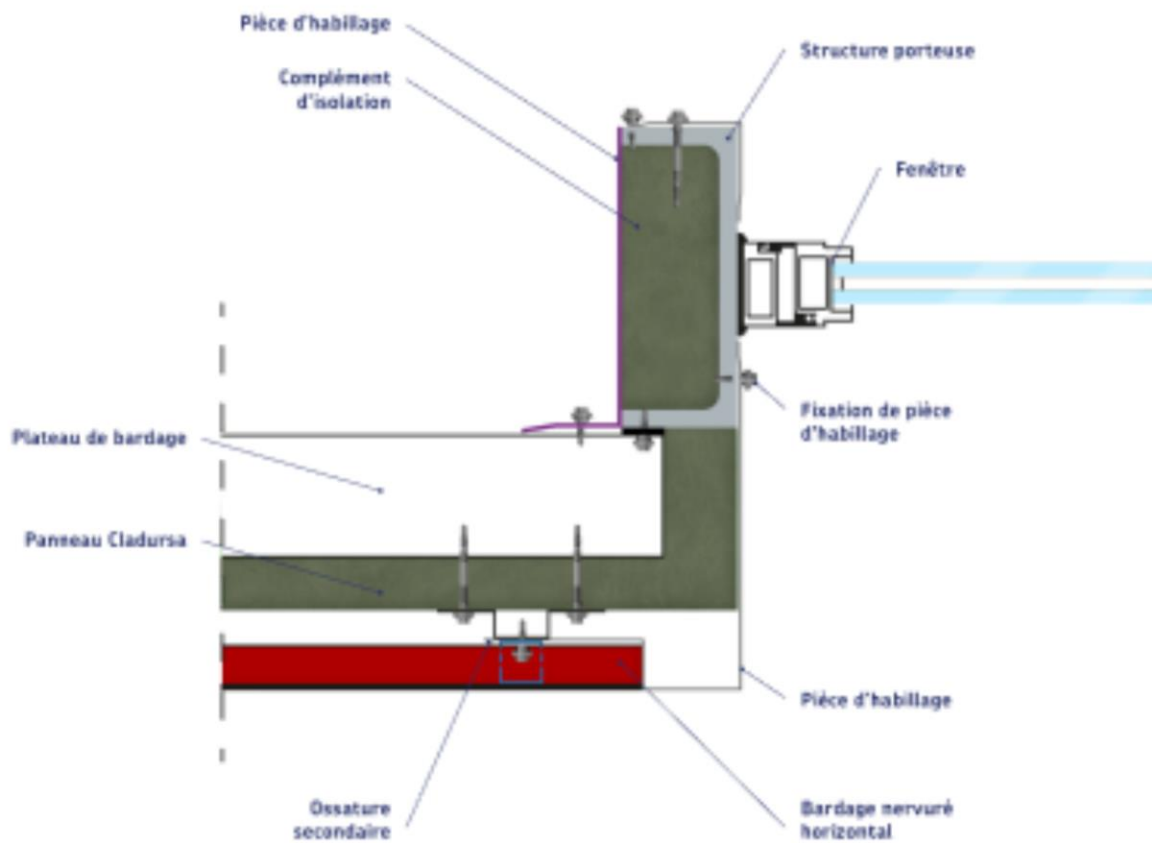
Coupe sur tableau - Exemple de solution avec ossature secondaire
